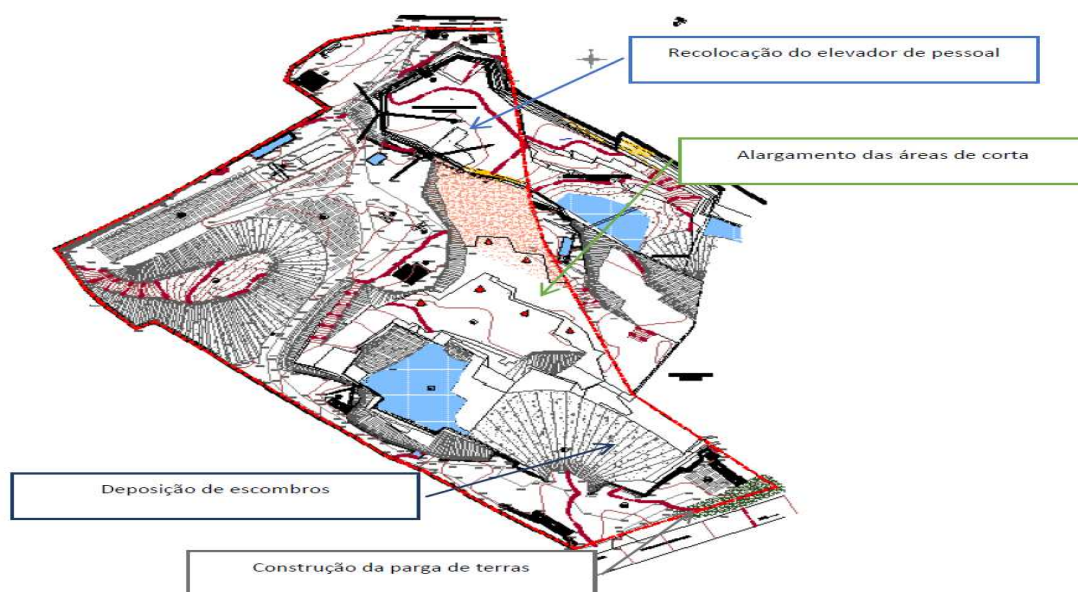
configuração prevista para o final da fase I da lavra (até ao 6.º ano)
